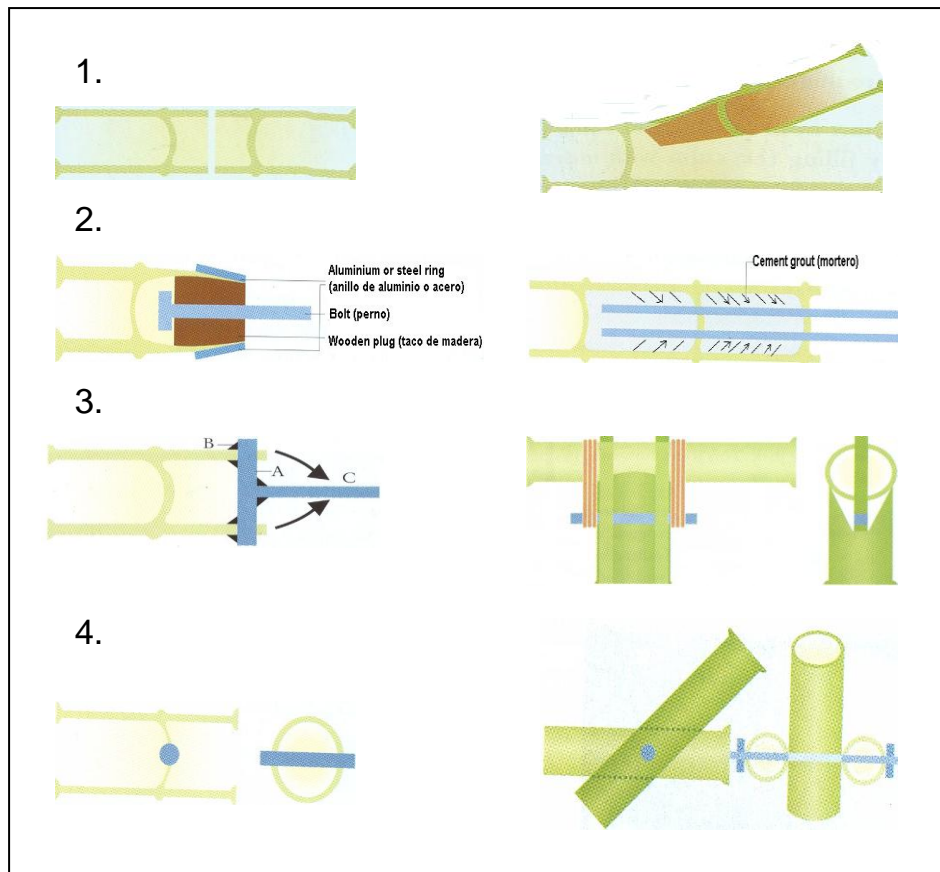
Diferentes tipos de Uniones utilizadas para construcción en caña. [Designing and Building with Bamboo, Jules J.A. Janssen]
